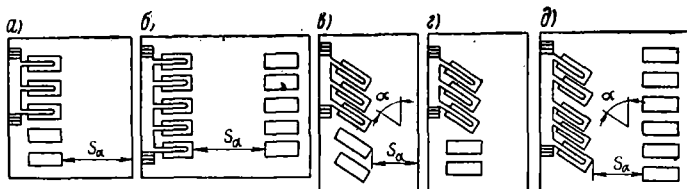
Схема планировки помещений разборочно-сборочных цехов
